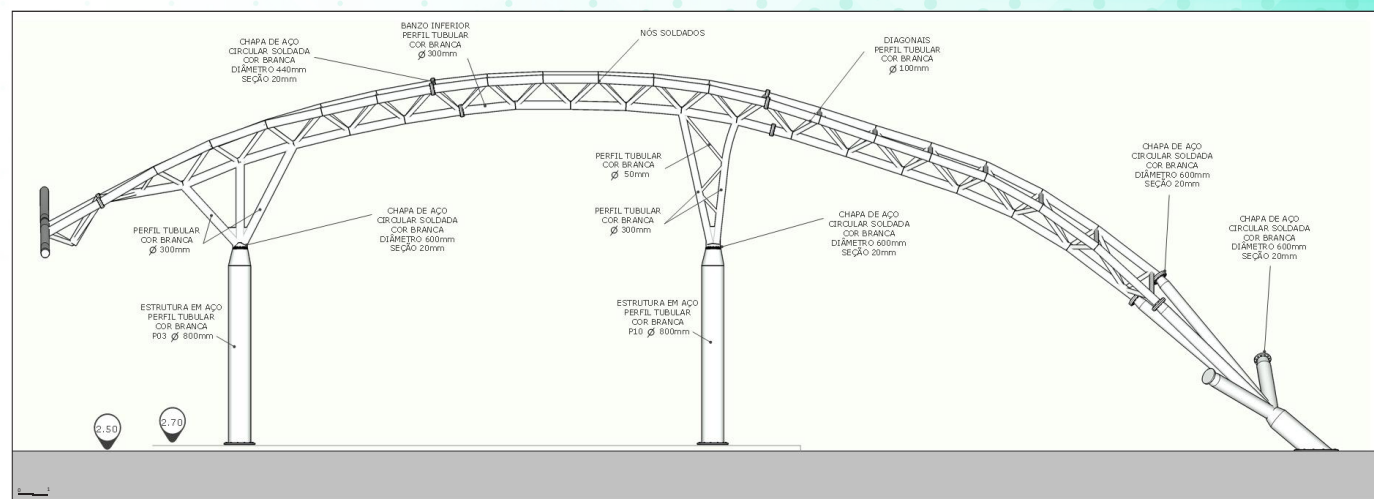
Detalhamento treliça 03. Elevação noroeste. Planta técnica anexa em escala 1:100. Rafael Rodamilans, 2018
